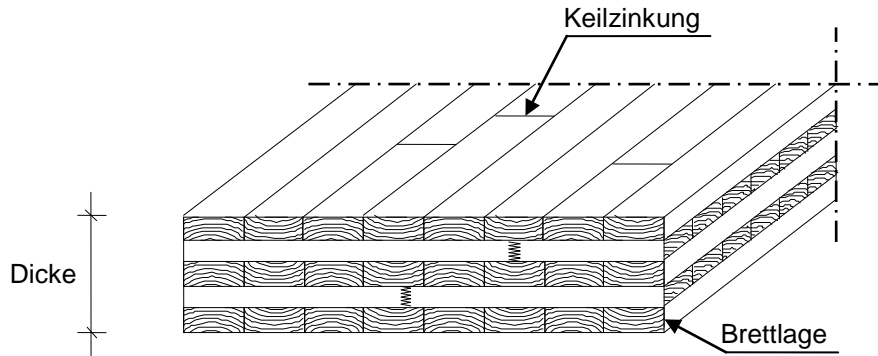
Grundsätzlicher Aufbau eines Brettsperrholzelements (fünf Lagen)
